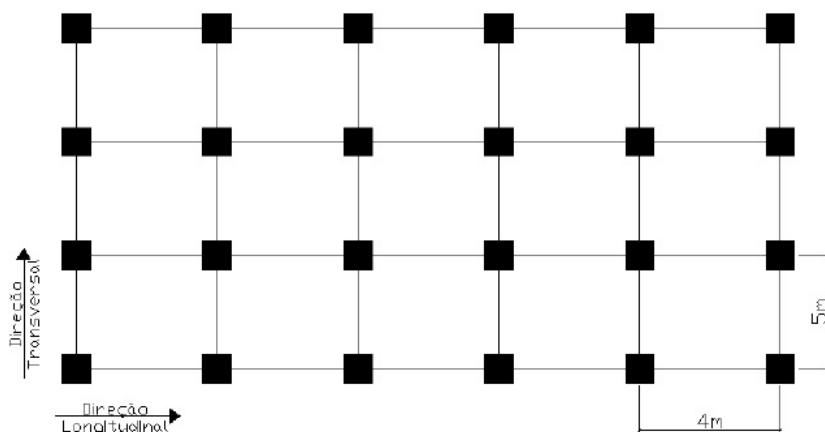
Disposição em planta do edifício PT8 [5]
